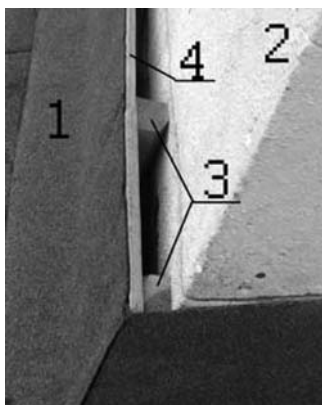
Примыкание однослойной кровли к стене (парапету) с продухом
